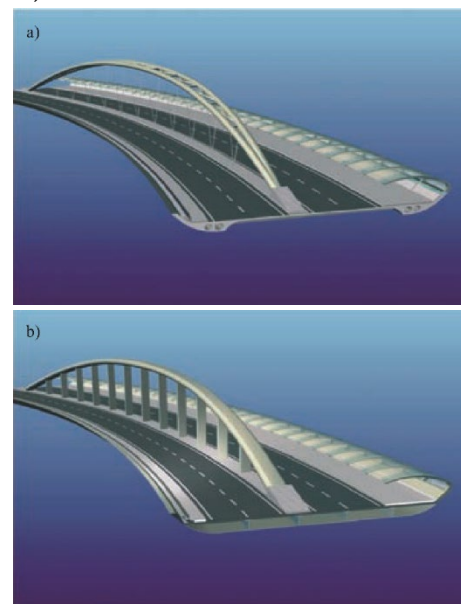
Puente sobre el río Galindo, soluciones no construidas. a) Arco en celosía, b) péndolas rígidas transversales.
